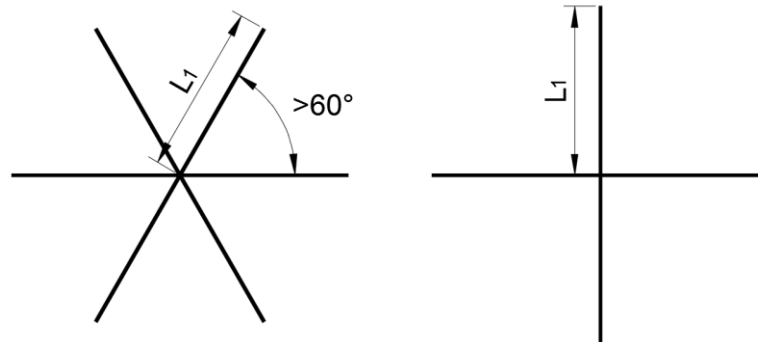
Grundriss Strahlenerder mit 60° -Winkel (links), Vierstrahlerder (rechts) (vgl. [33])
